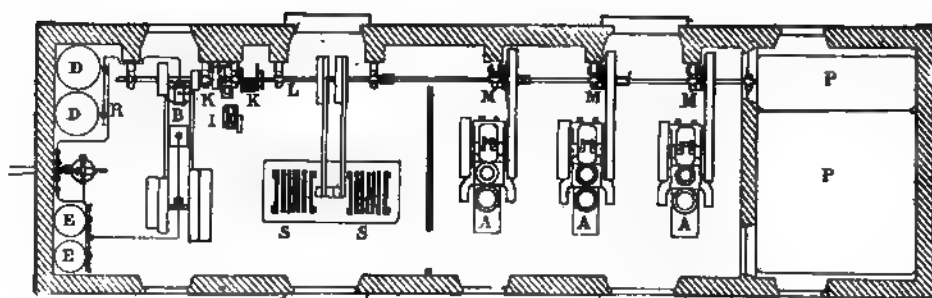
Installation de la machinerie du phare de Belle-Ile.
